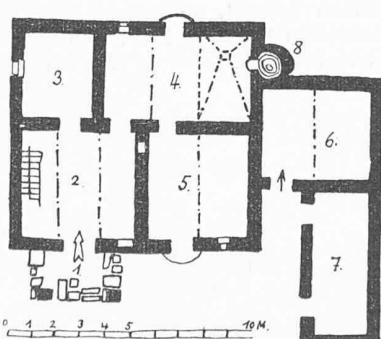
Grundriss des Bauernhauses auf Ibiza, 1:300. 1 Gedeckter Eingang, 2 Porchu (Diele), 3 Kammer, 4 Küche, 5 Kammer, 6 Ställe, 7 Schopf und Kleinviehstall, 8 Backofen
